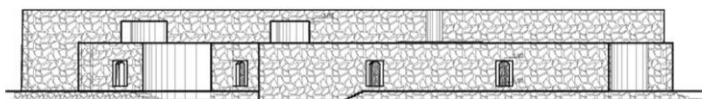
Vista exterior de proyecto. Fuente: ArchDaily
